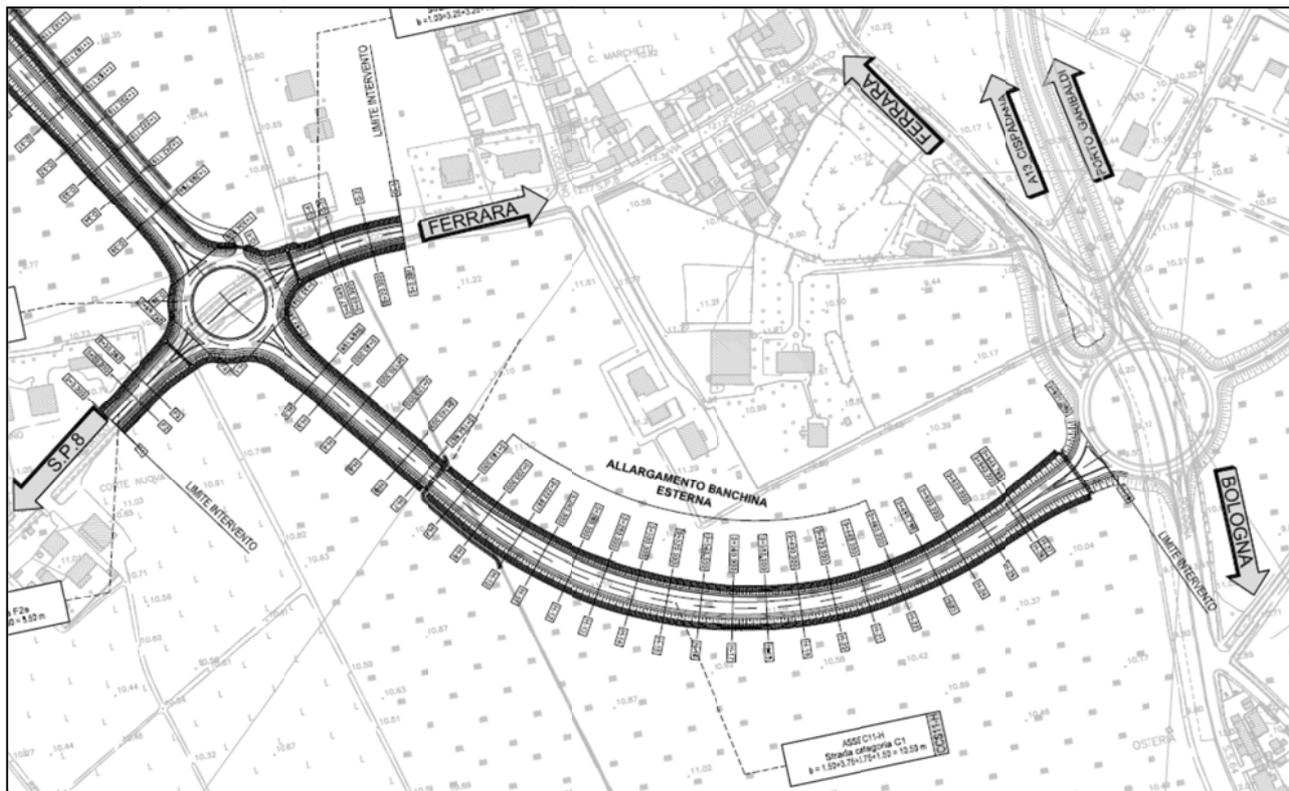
STRALCIO PLANIMETRICO INNESTO PROLUNGAMENTO TANG. OVEST DI FERRARA CON ROTATORIA SULLA SS64 PORRETTANA
